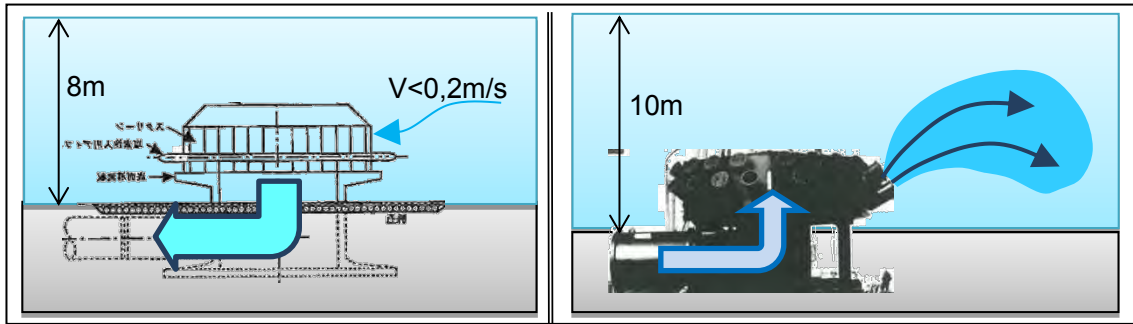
Coupes imagées des conduites (en haut :refoulement ; en bas : prise et rejet)
